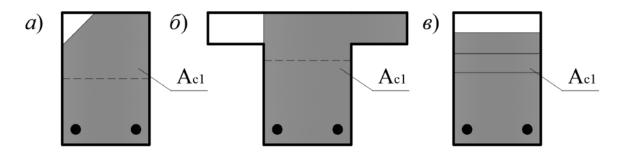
Определение геометрических размеров поперечного сечения за вычетом разрушенного участка
